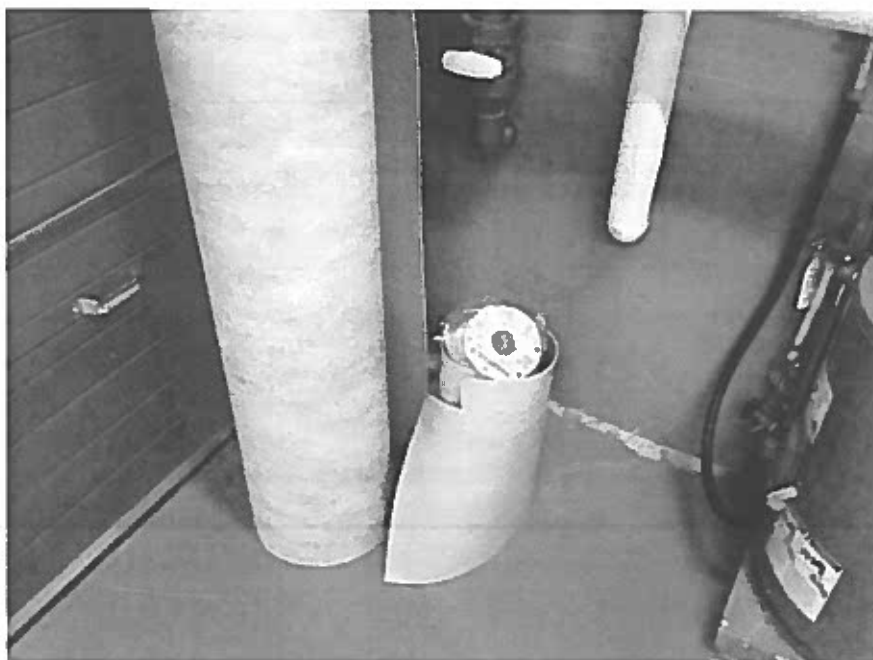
Rez-de-chaussée – Linoléum orange et linoléum orange et brun,
